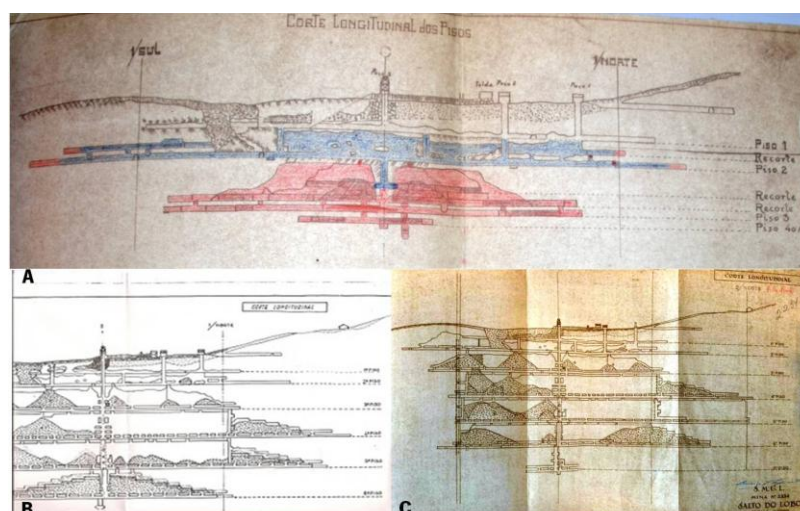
Três cortes longitudinais da Concessão Salto do Lobo, Minas dos Carris. A – Planta dos trabalhos realizados em 1953, até ao 4º piso. B - Planta dos trabalhos realizados em 1956, até ao 6º piso, C - Planta dos trabalhos realizados em 1957, até ao 7º piso (fonte Rui Barbosa, 2013, <http://carris-geres.blogspot.com>).
